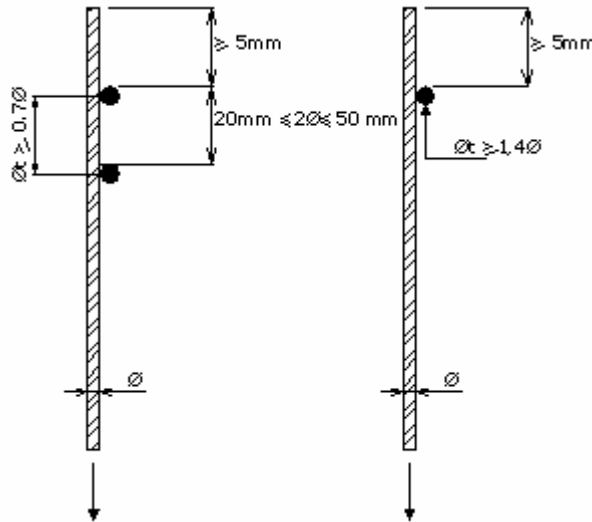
Ancoragem de armadura transversal por meio de barras soldadas
